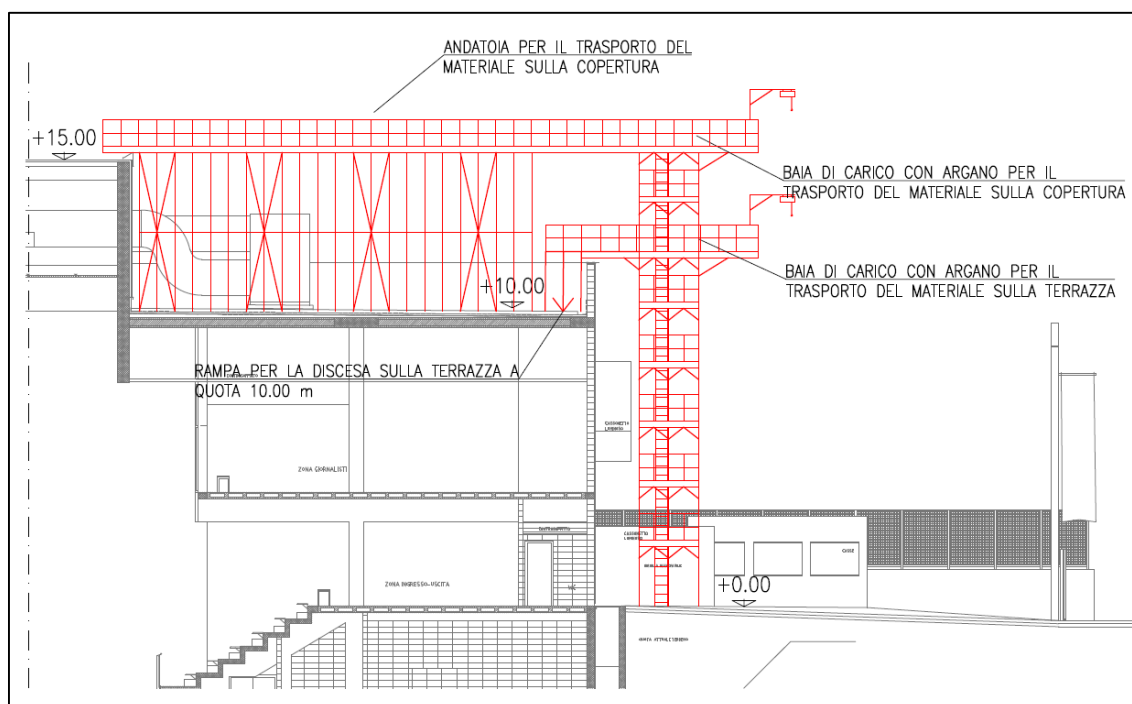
Sezione ponteggio con indicazione passerella e baie di carico.
